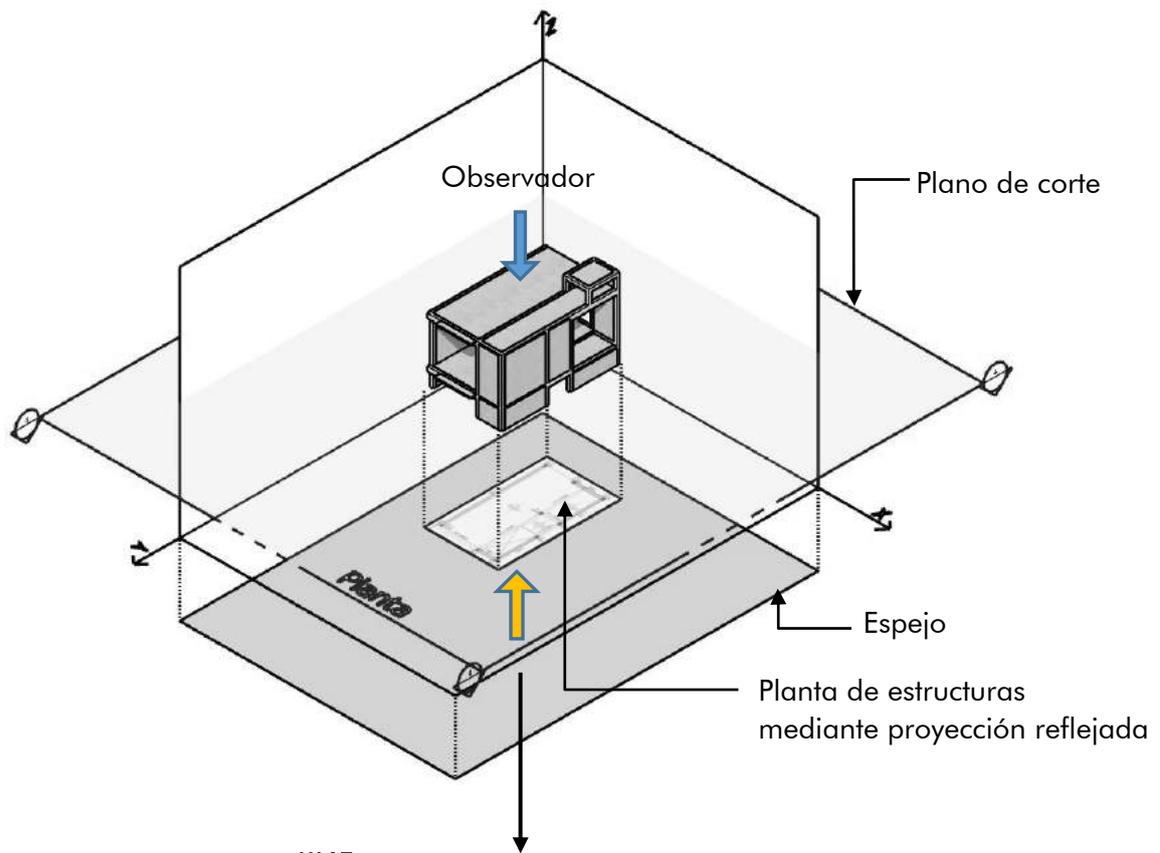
Losa sobre planta baja - Método de proyección ortogonal reflejada
